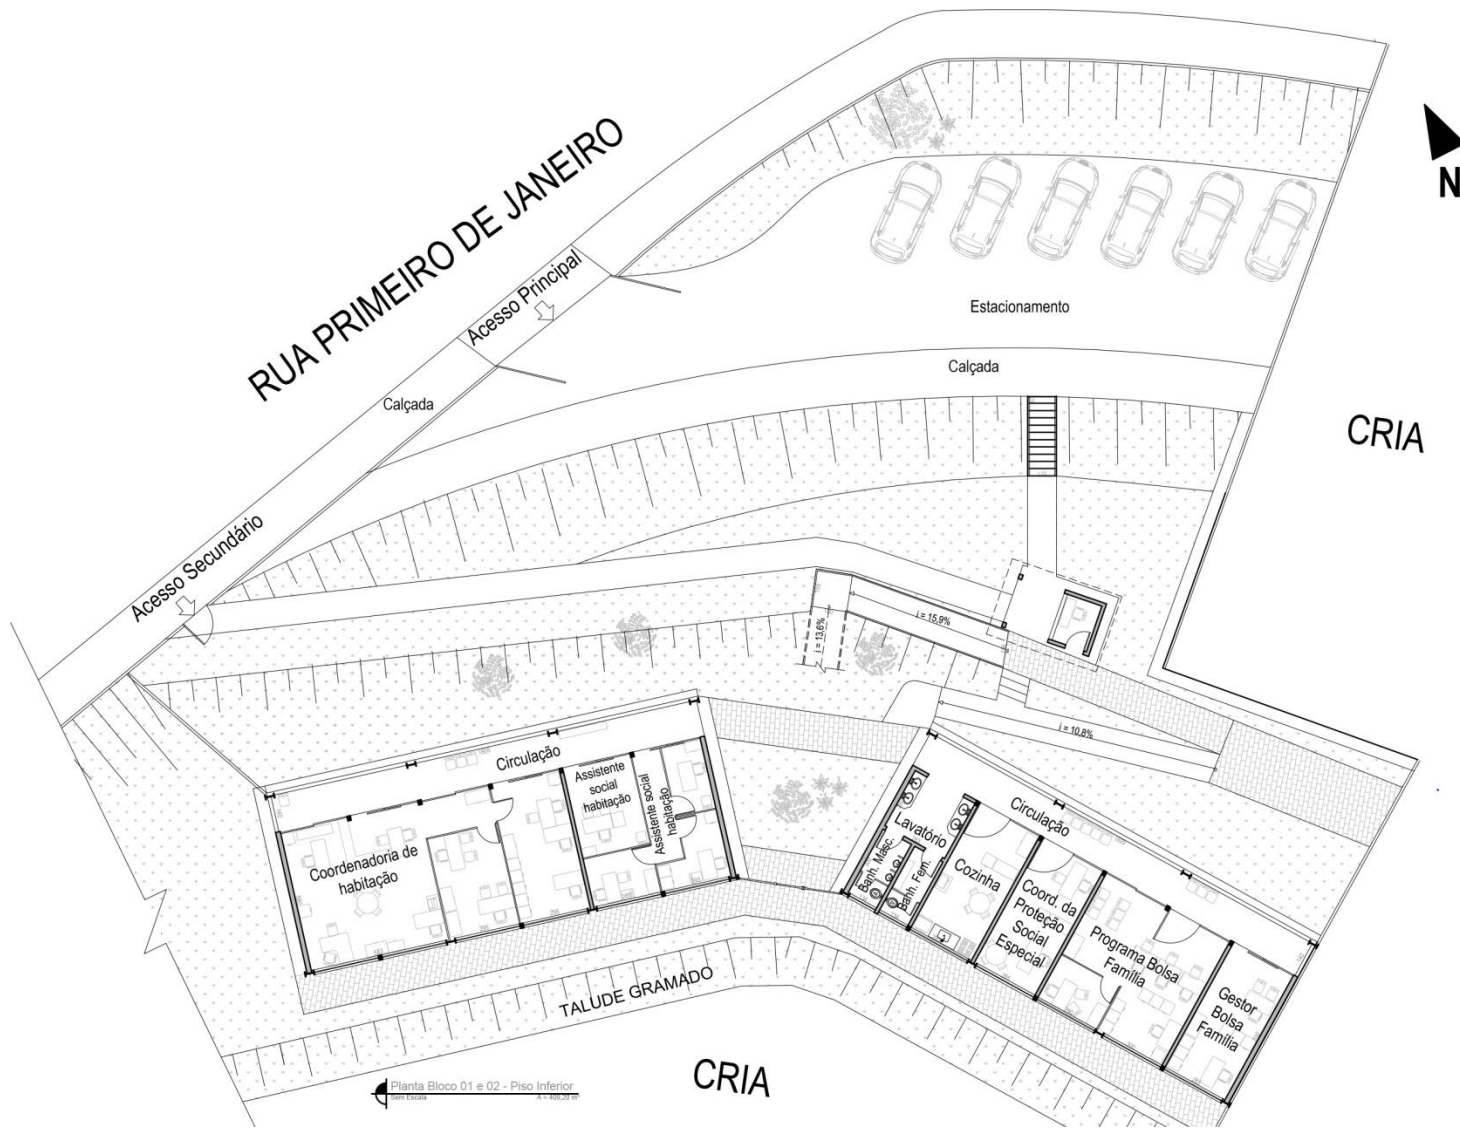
Planta Baixa com Layout do Primeiro Pavimento da SEDESC.
